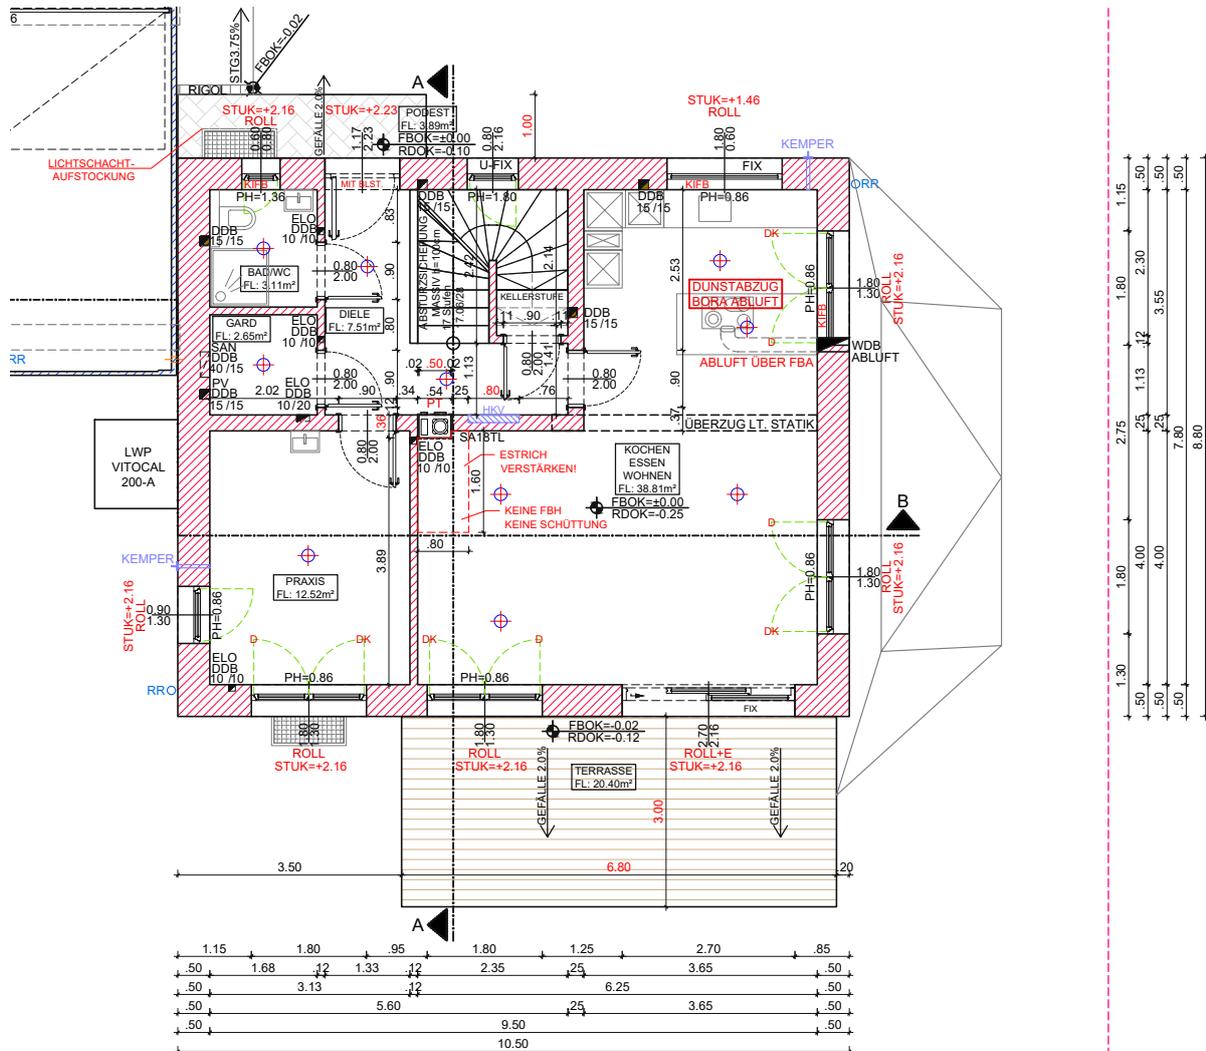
Erdgeschoss – Ausführungsplan [39]
